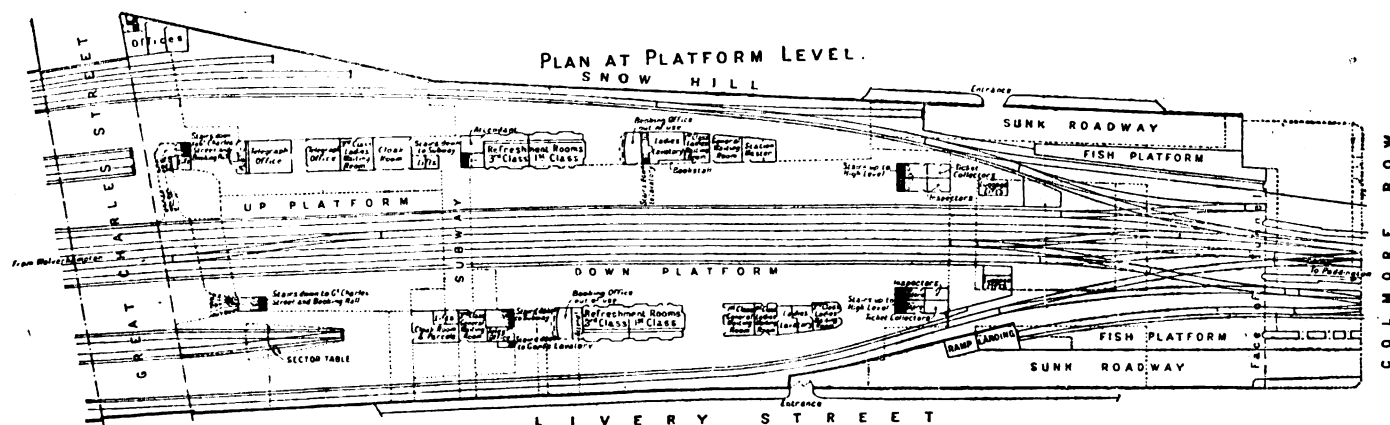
Nuova stazione Snow Hill di Birmingham - Planimetria generale.
